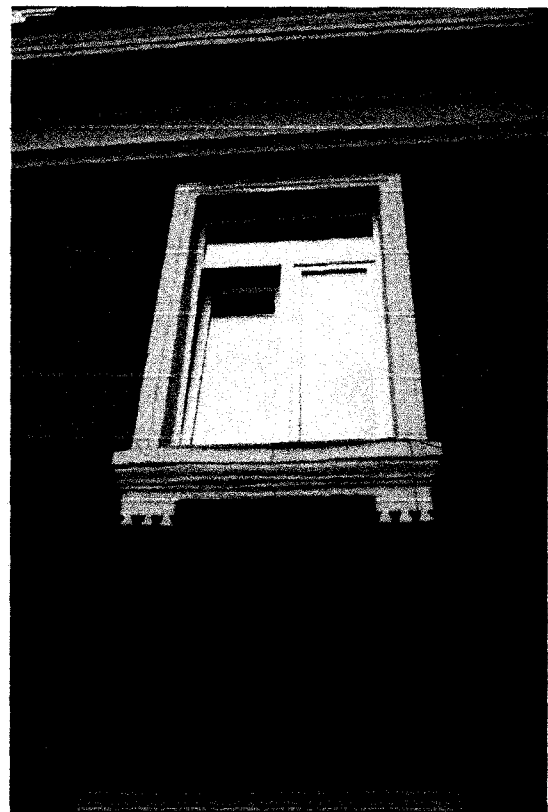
Фрагмент главного фасада основного корпуса. Оконные проемы 1 и 2 этажей. Межэтажные пояса
